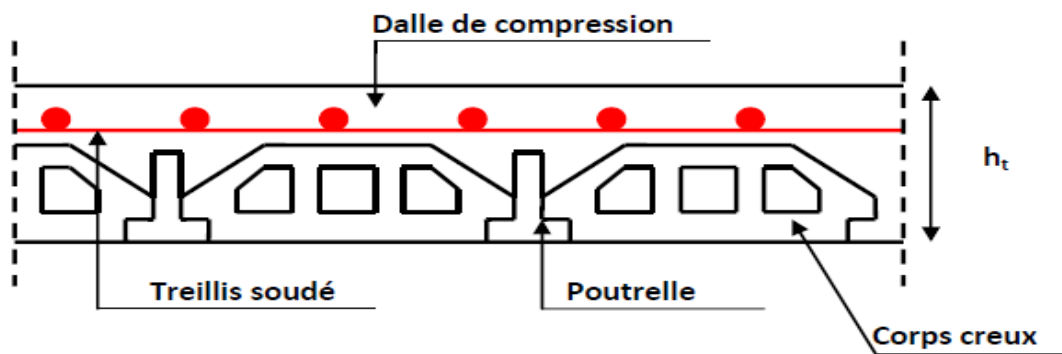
Coupe transversale du plancher en corps creux.
